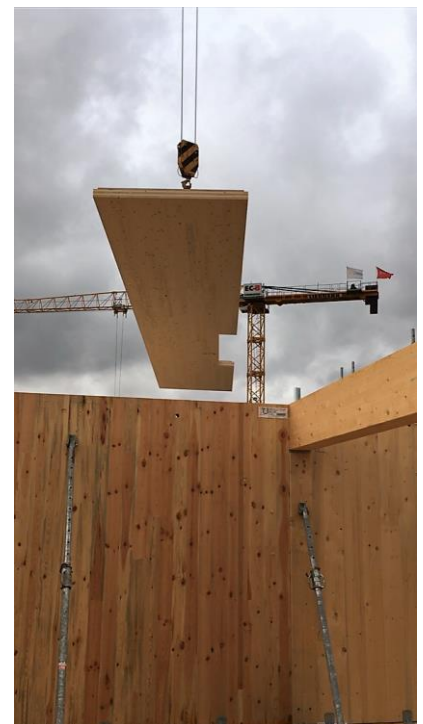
Mise en place d'un plancher au niveau R+3 sur un chantier à Ris Orangis (91)
